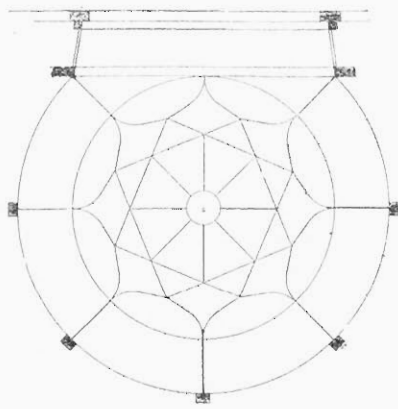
Théâtre Populaire, plan du plafond de la salle.
